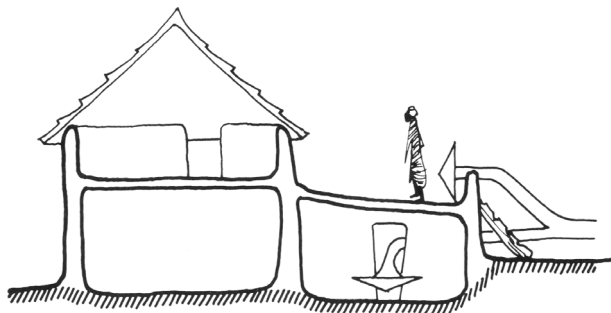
Sección esquema acceso viviendas de dos plantas
